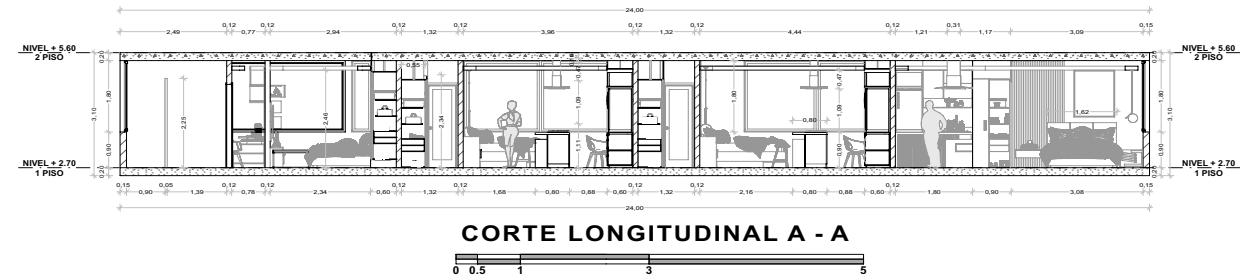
Autoría Jose Cruz. Corte Longitudinal.
